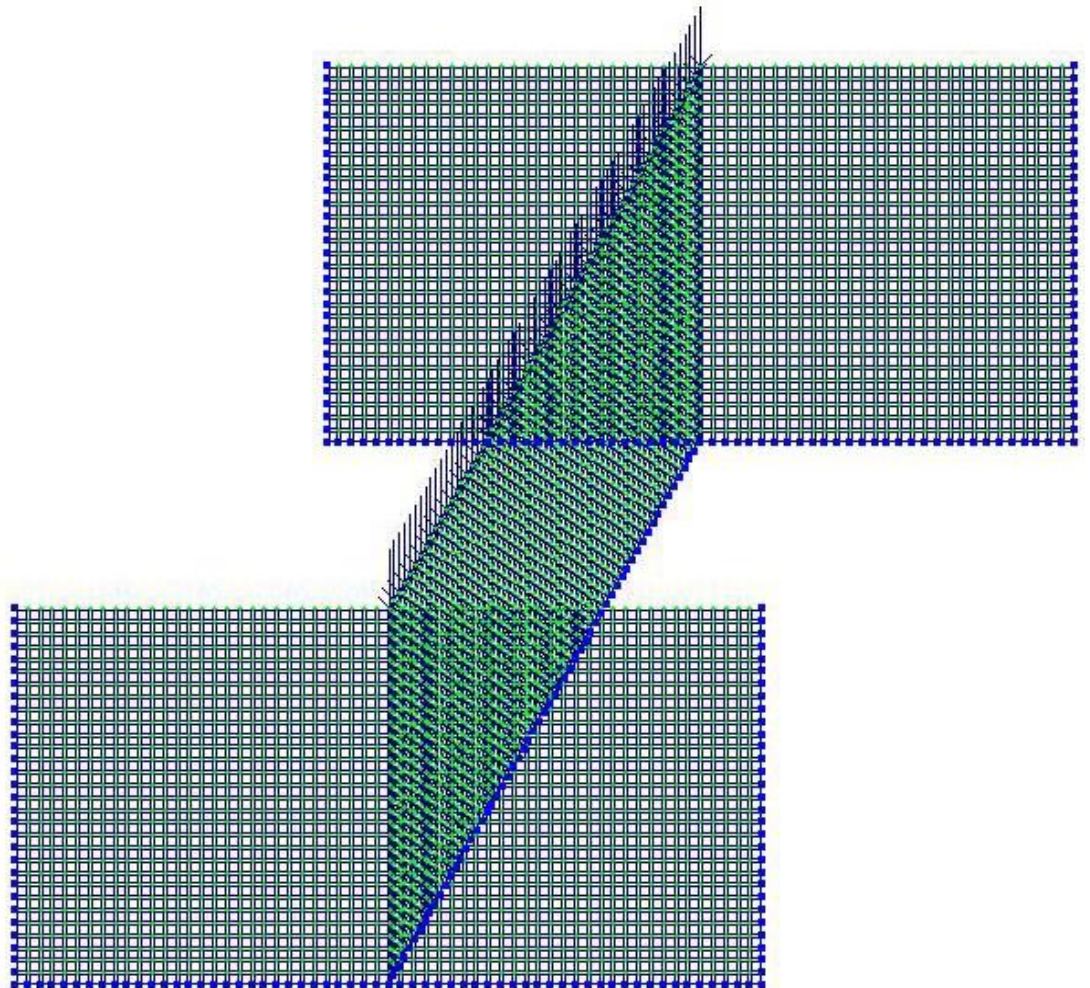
Расчетная схема сопряжения разнодеформируемых стен при нагружении внутренних стен
